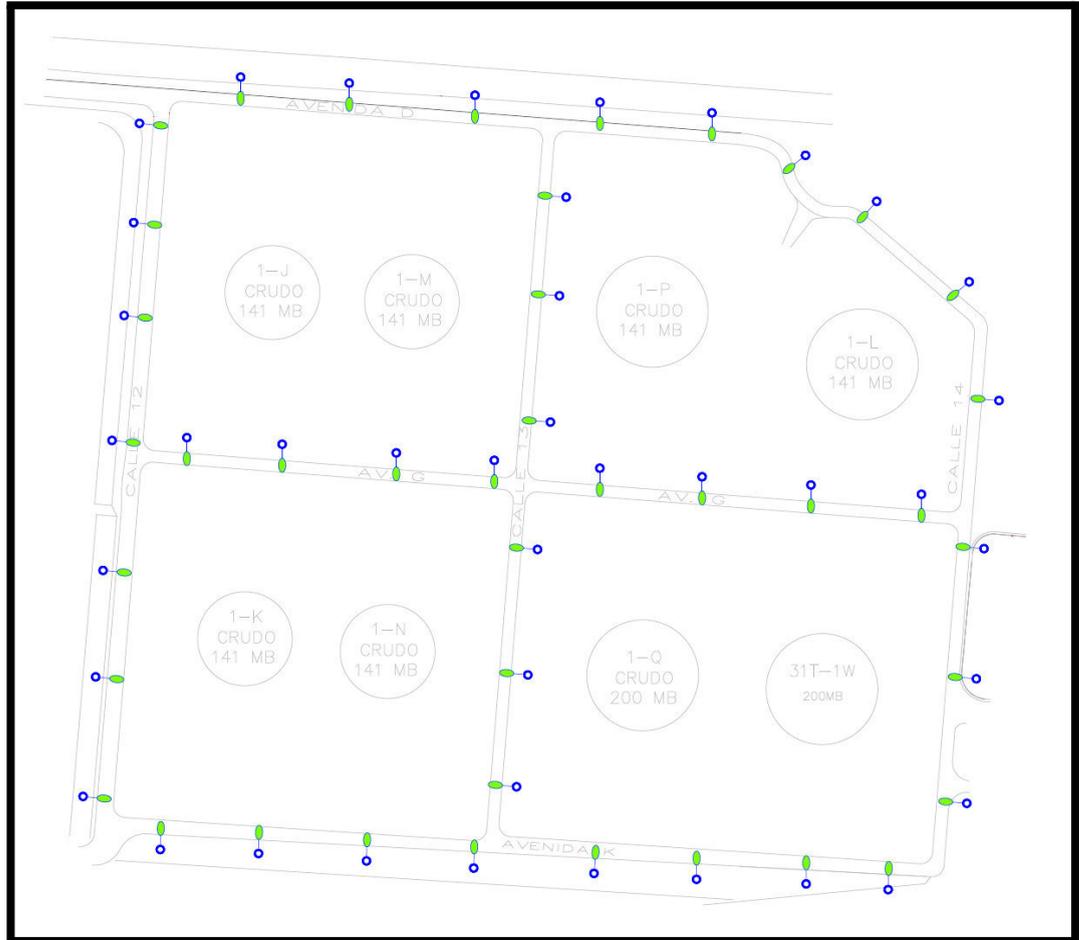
FIGURA SEQ FIGURA_ *ARABIC 6: Plano de distribución Final de Iluminación-Vista de Planta
